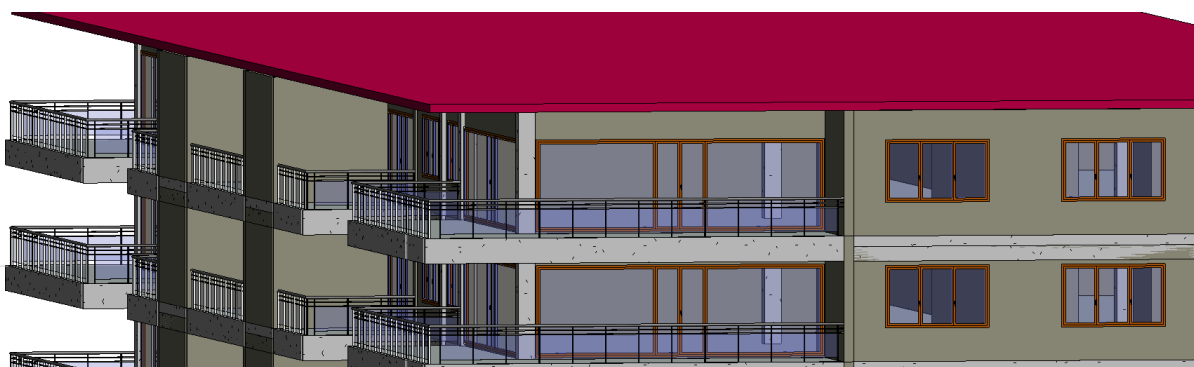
Fachada del Edificio (puertas y ventanas)
